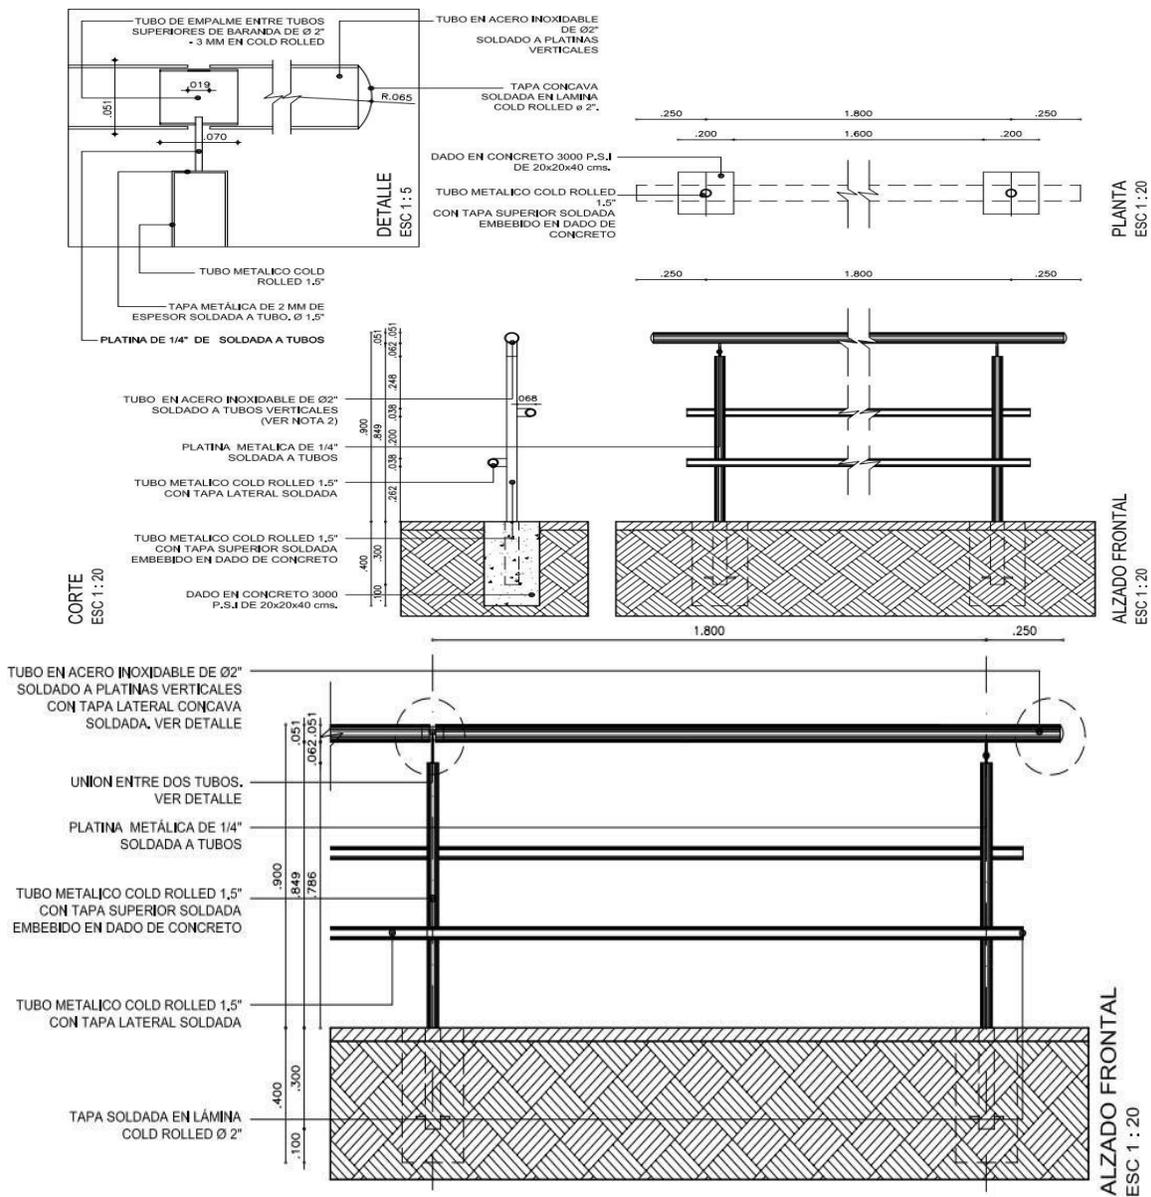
Diseño de barandas M81 tomado de la Secretaría Distrital de Planeación.
